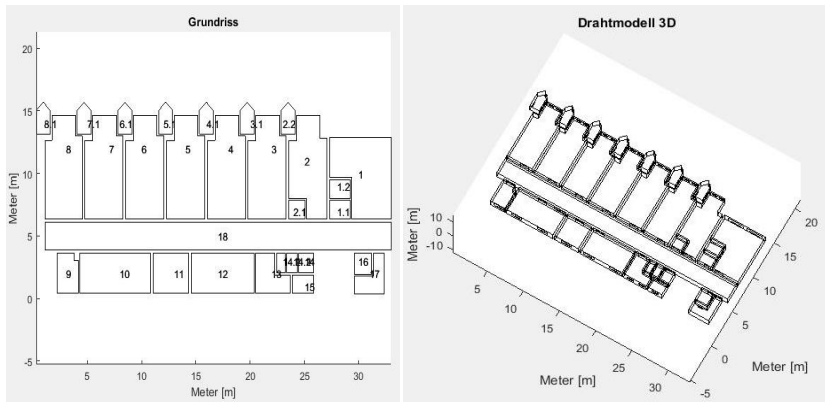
Graphische Ausgabe aus dem ResourceApp-Modell, Grundriss (links) und Drahtmodell (rechts)
